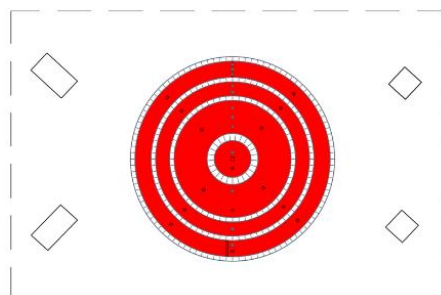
Planta: Área de rojo indica el sector de fondo de las pozas a aplicar impermeabilizante.
